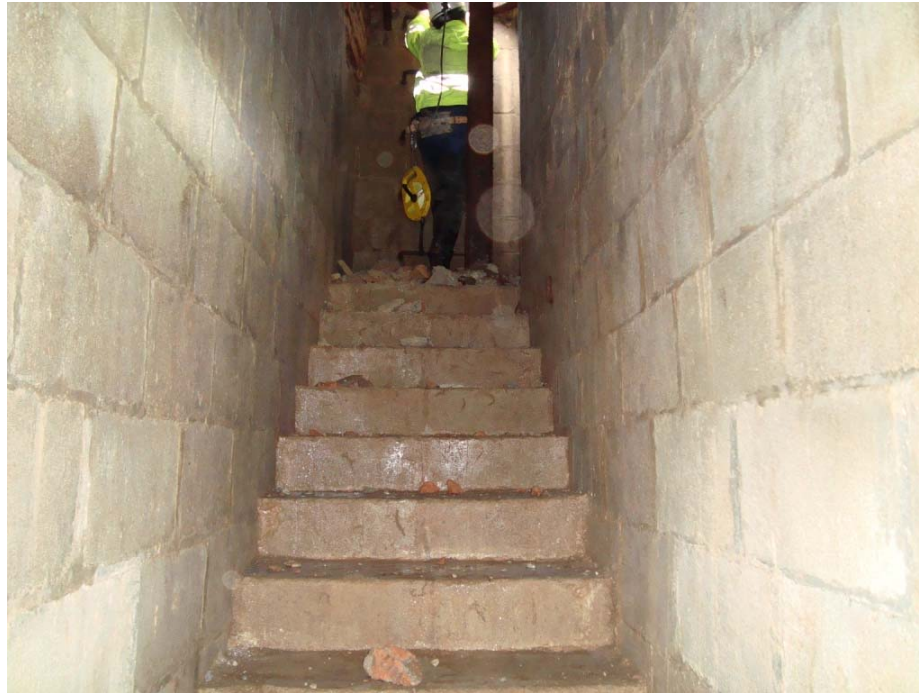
Punt d'accés mitjançant pou de registre. Primer tram d'escales trobat
